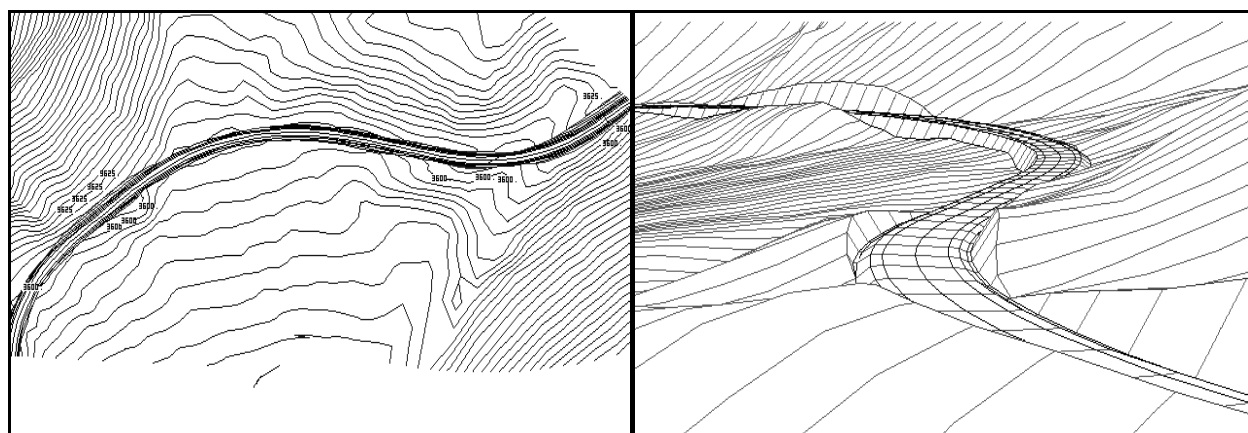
Vistas sistema EICAM – Proyecto terminado en planta y perspectiva 3D.
